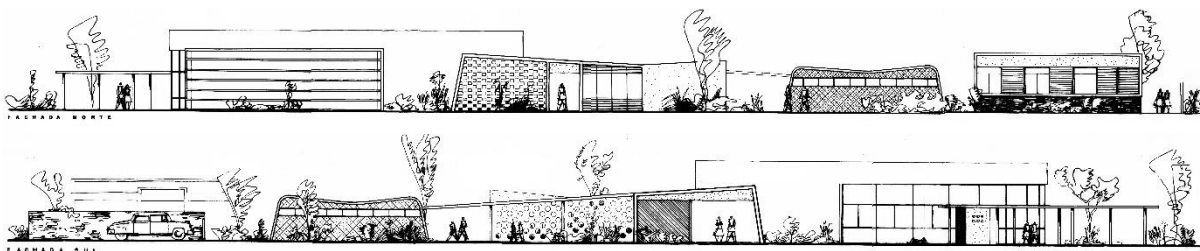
Fachadas norte e sul do anteprojeto da SAPI. Fonte: Alessandra Szekut
